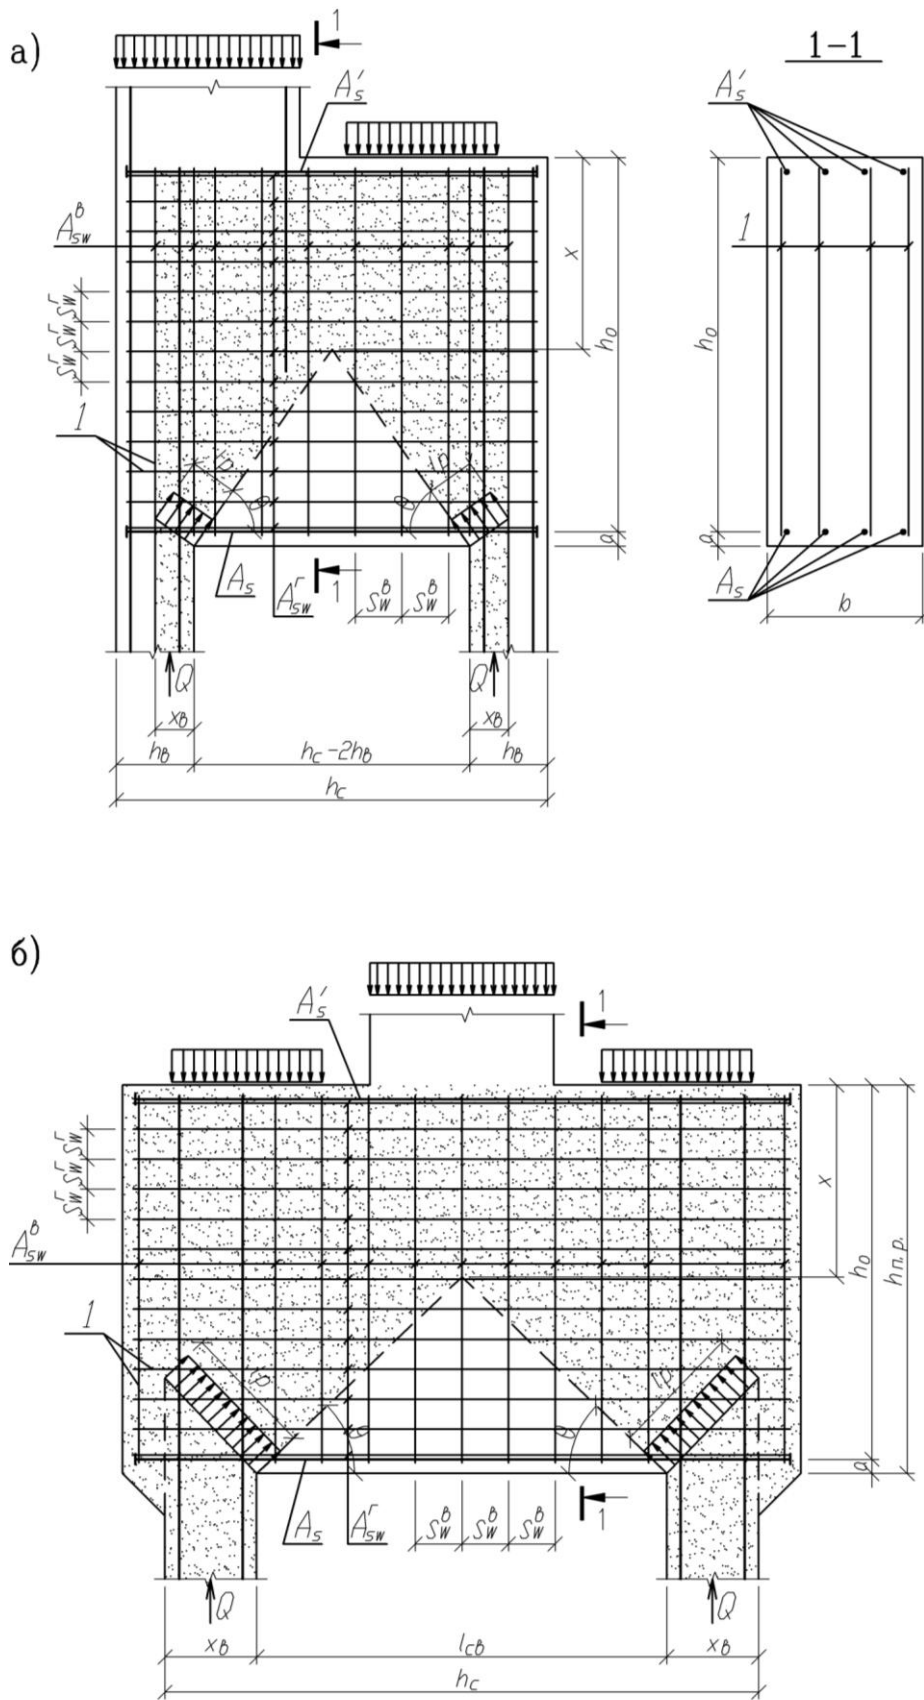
К расчету подкрановой распорки крайней (а) и средней (б) колонны; 1 – сварные сетки
